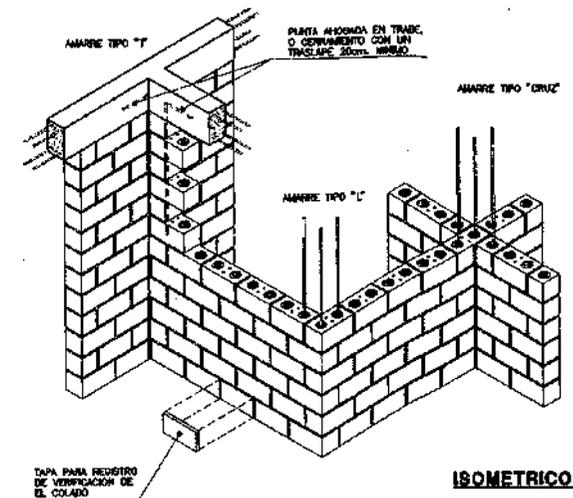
Detalle muro, fuente Detalles de Arquitectura, Miguel Murguía Díaz.
